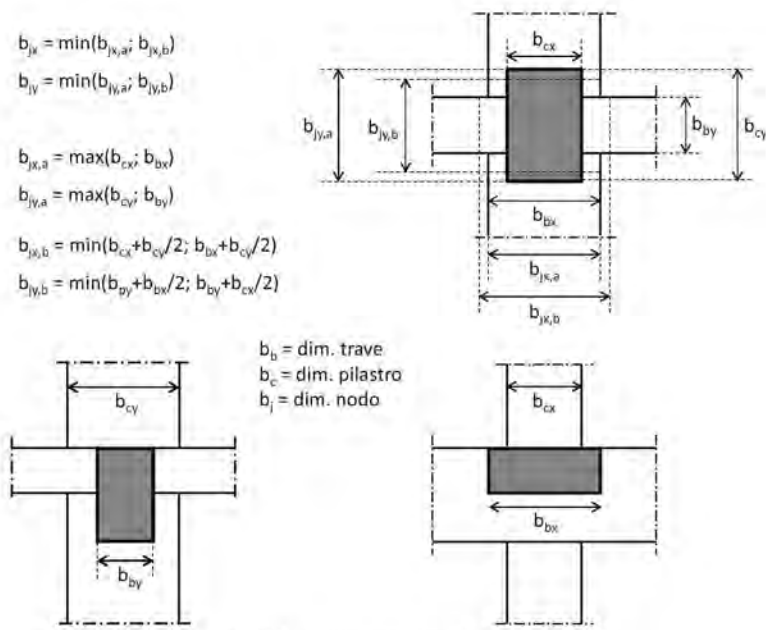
Dimensione efficace dei nodi trave-pilastro
